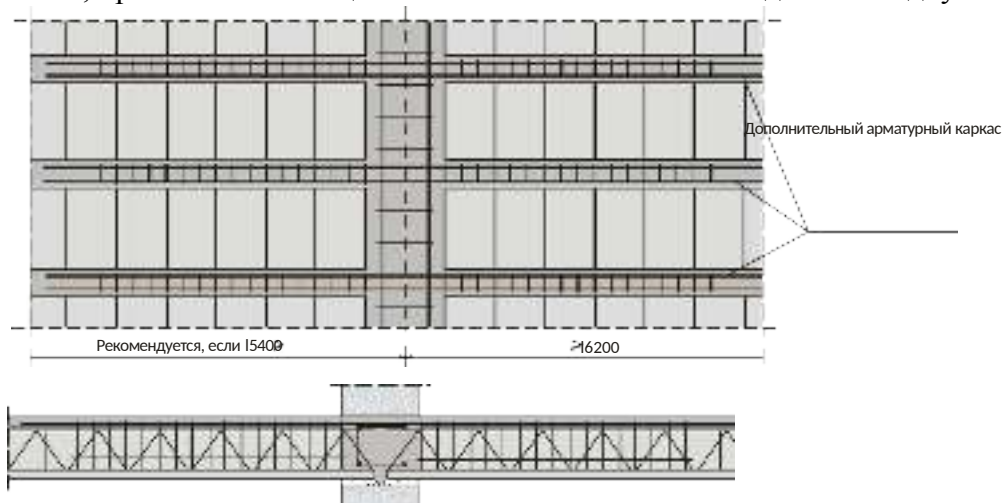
Расположение дополнительного арматурного каркаса в местах опоры перекрытия «TERIVA-II», длиной более 720 см, а также перекрытия «TERIVA-III», длиной более 600 см на несущие стены.
